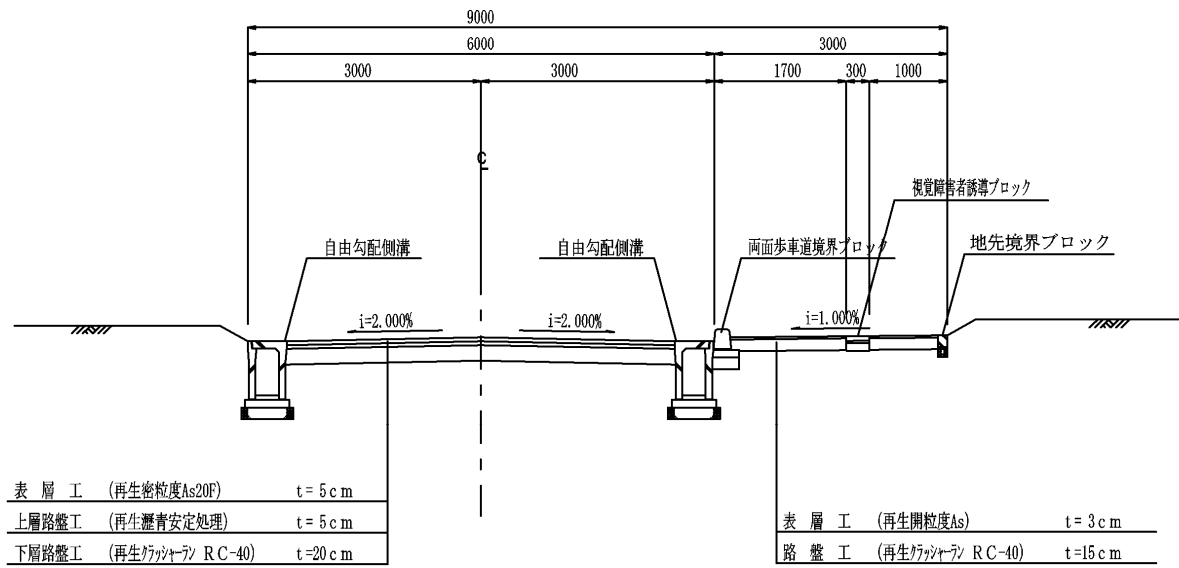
(5) 道路標準断面図(主要区画道路:9m)
